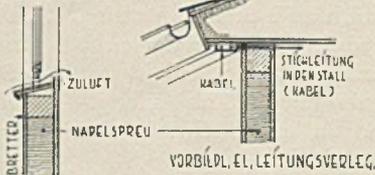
Einzelheiten des Stallbaues der Kleinstsiedlung als Doppelhaus
